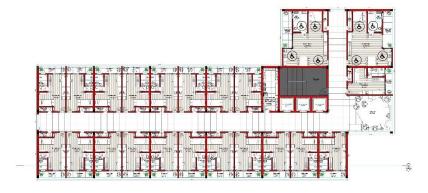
Planta baixa do Bloco B – Pavimento TIPO.
